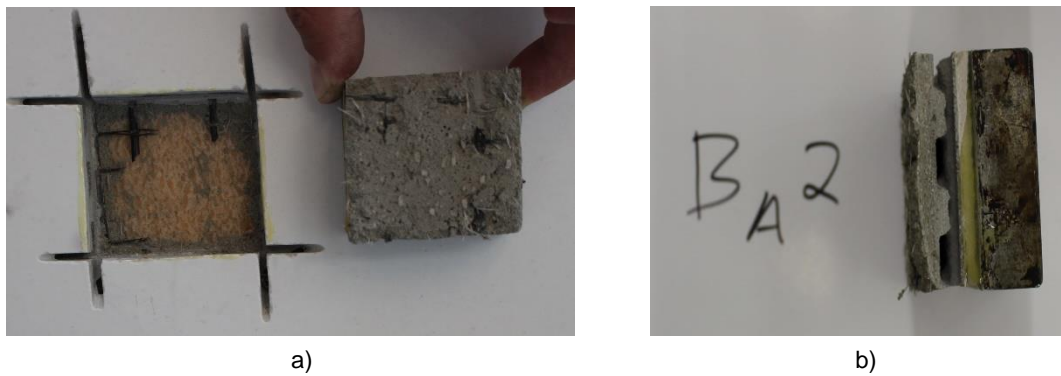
Ensaio de aderência Ba₂: a) Vista de frente; b) Vista em perfil
